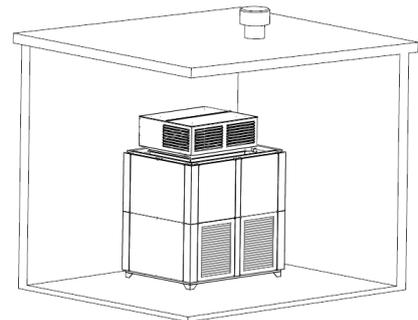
Exemple de montage à l'intérieur du bâtiment
